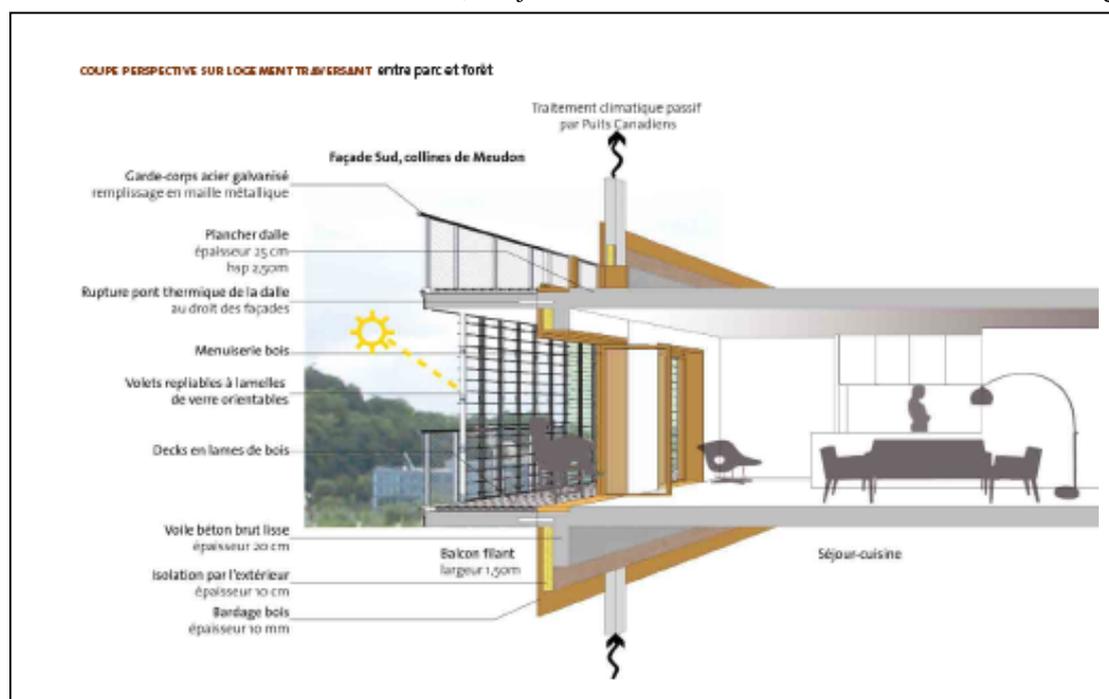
Projet abandonné de puits canadien passant en façade du bâtiment (façade sud)
